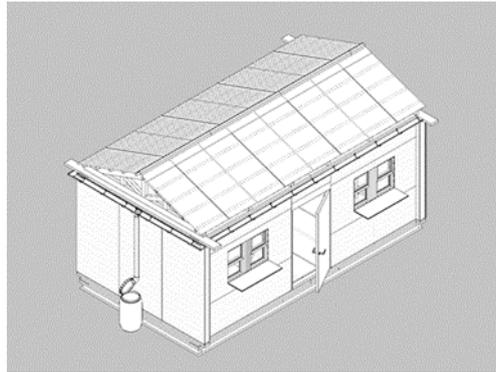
Proceso constructivo cuarta etapa, segunda propuesta.
